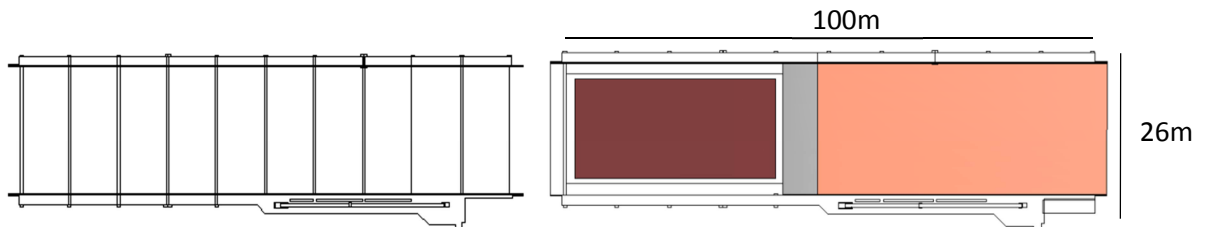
plan du hall de stockage et plan avec proposition, source: cimenterie de Rais Hamidou
